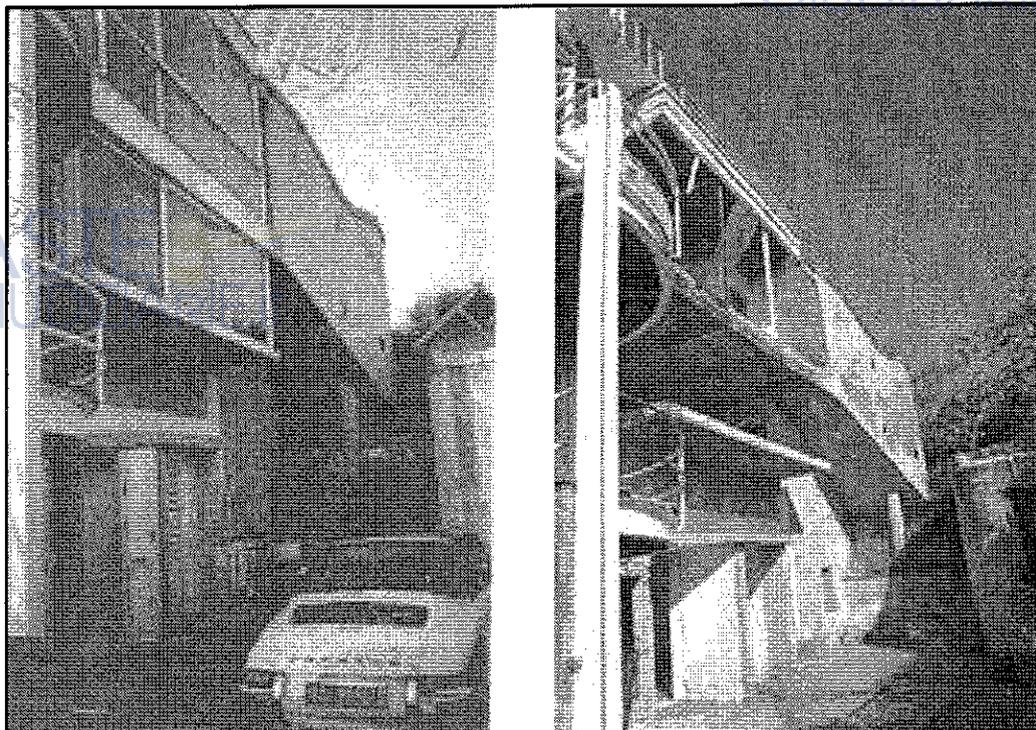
Prospetto Sud. Raffronto tra una foto tratta dall'Autorizzazione prot.18301 del 1998 (allegato n. 10) e lo stato attuale.
